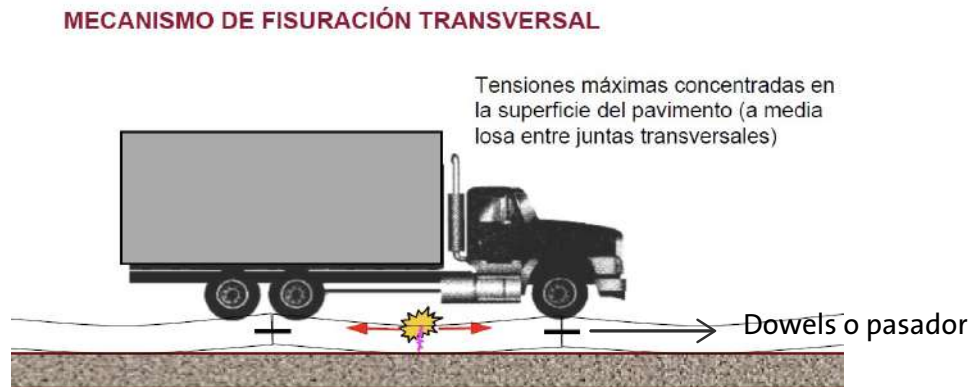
Alabeo del paño del pavimento rígido. La masa del camión descargando en los bordes de la losa provoca su rotura en el centro. Imagen obtenida de la Tesis de Maestría del Ing. Christian Rojas. Bolivia: “Estudio de Desempeño del pavimento Rígido Ancavari-Huachacalla Mediante Análisis Estructural por Elementos Finitos”
